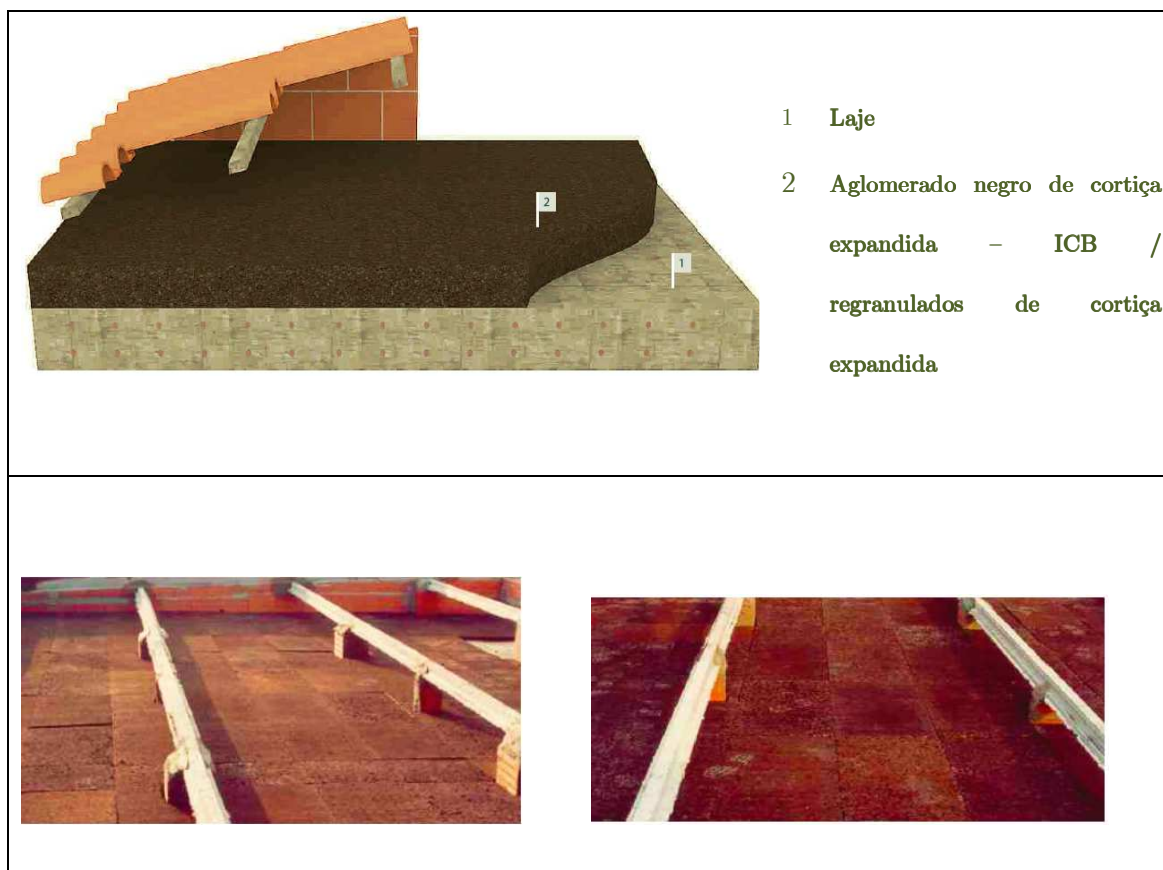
Exemplo de isolamento térmico e acústico utilizando cortiça em lajes de esteiras horizontais (sótãos não visitáveis) [24; 26]
